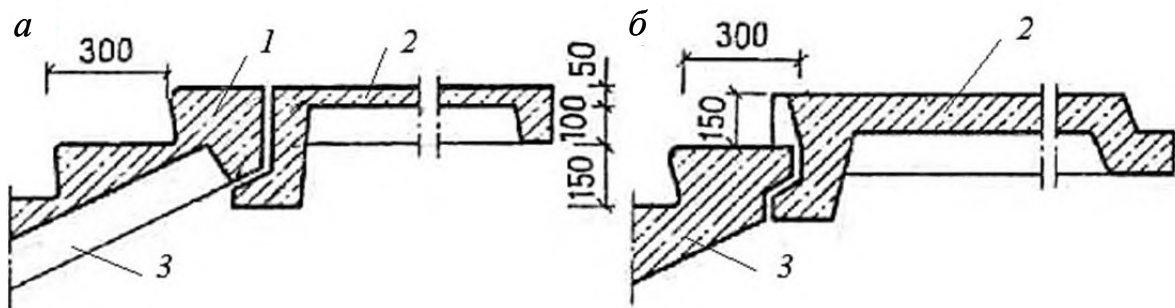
Лестница плитной и ребристой конструкции:
